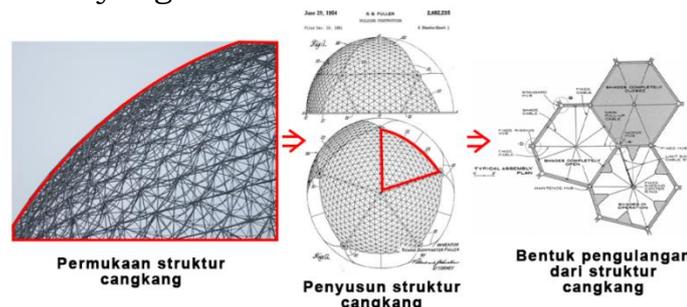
Prinsip Unity bangunan utama dengan struktur cangkang bangunan
